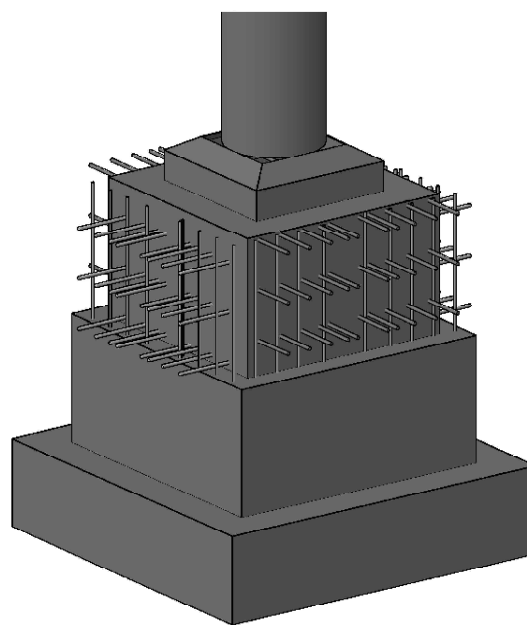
Заделка арматурных стержней в верхней части фундамента
